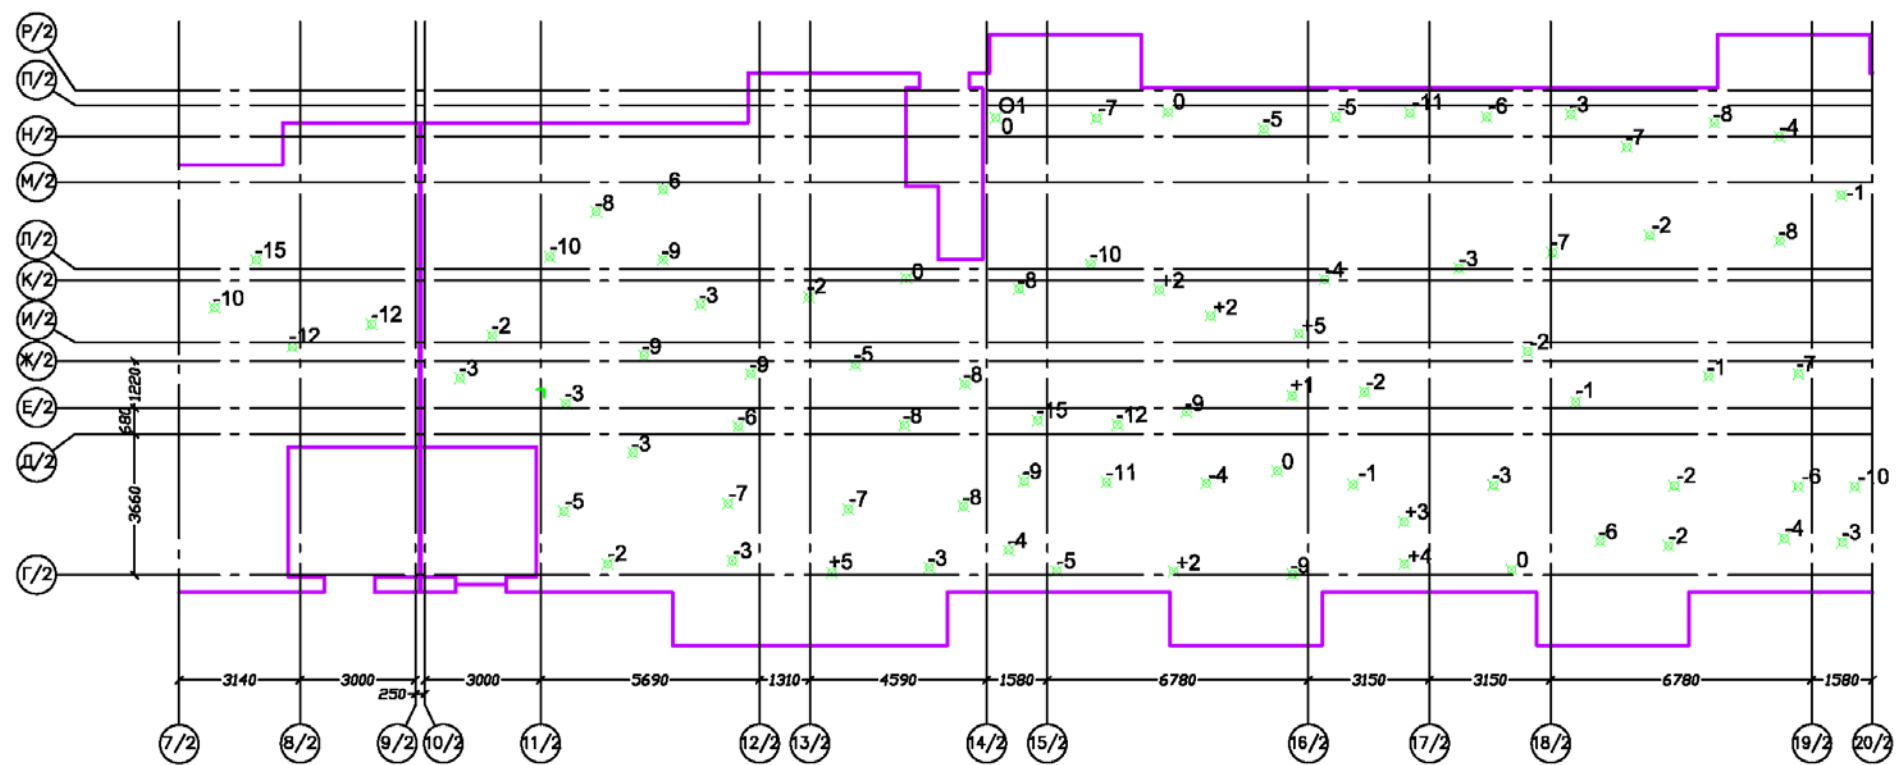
Обмерный план плиты перекрытия третьего этажа и вертикальных монолитных конструкций четвёртого этажа
